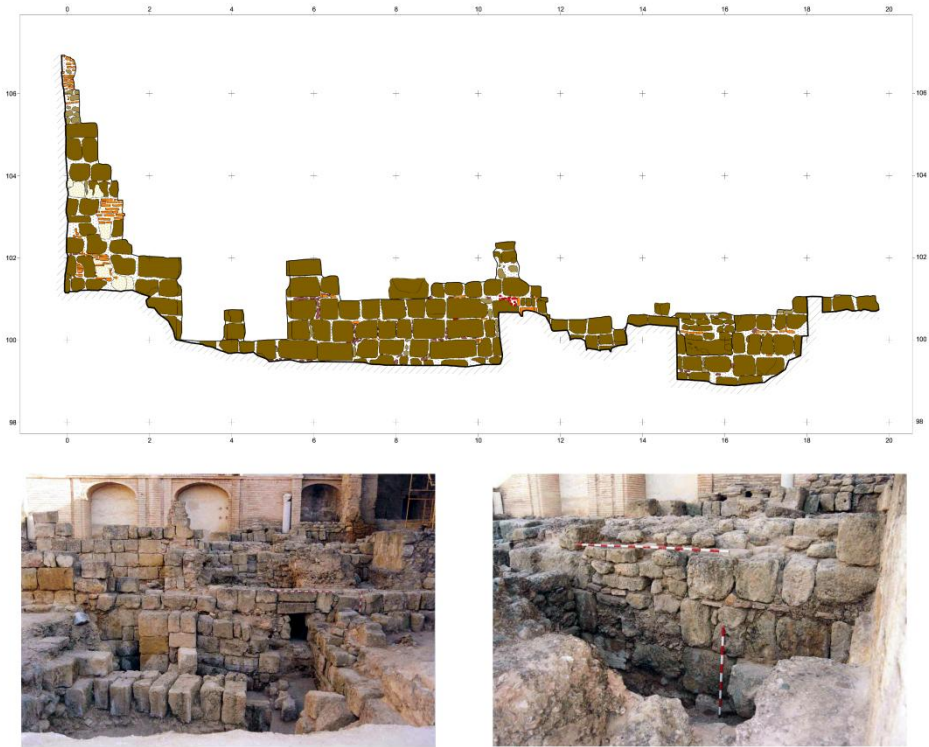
Alzado del muro almohade situado al norte del patio, con doble vano que marca la orientación de las estructuras posteriores conservadas; cegamiento de uno de los vanos almohades
